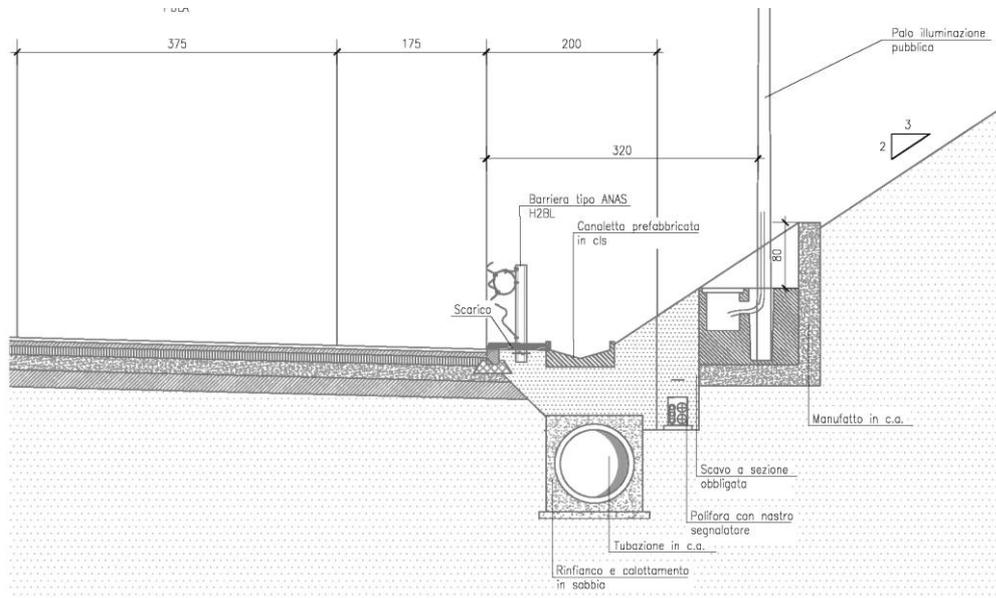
Protezione di progetto asse principale tratti bordo laterale in sterro
